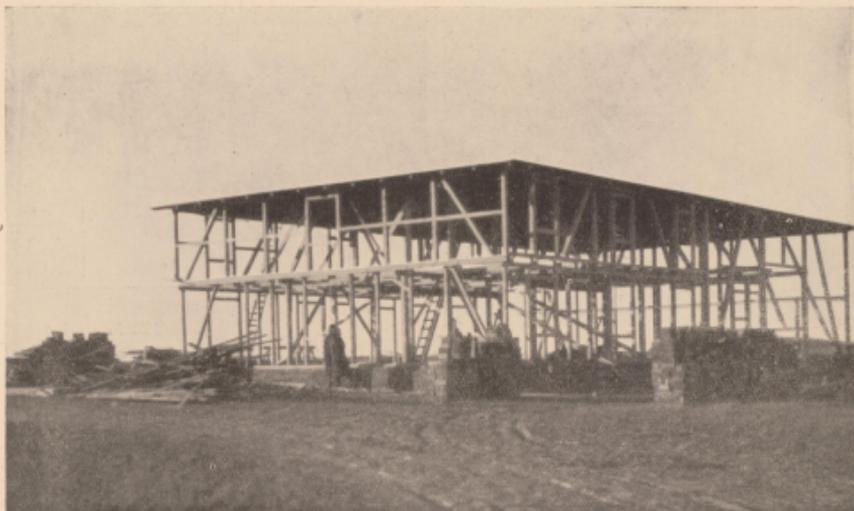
Vollbauernstelle im Holzsachwertebau
